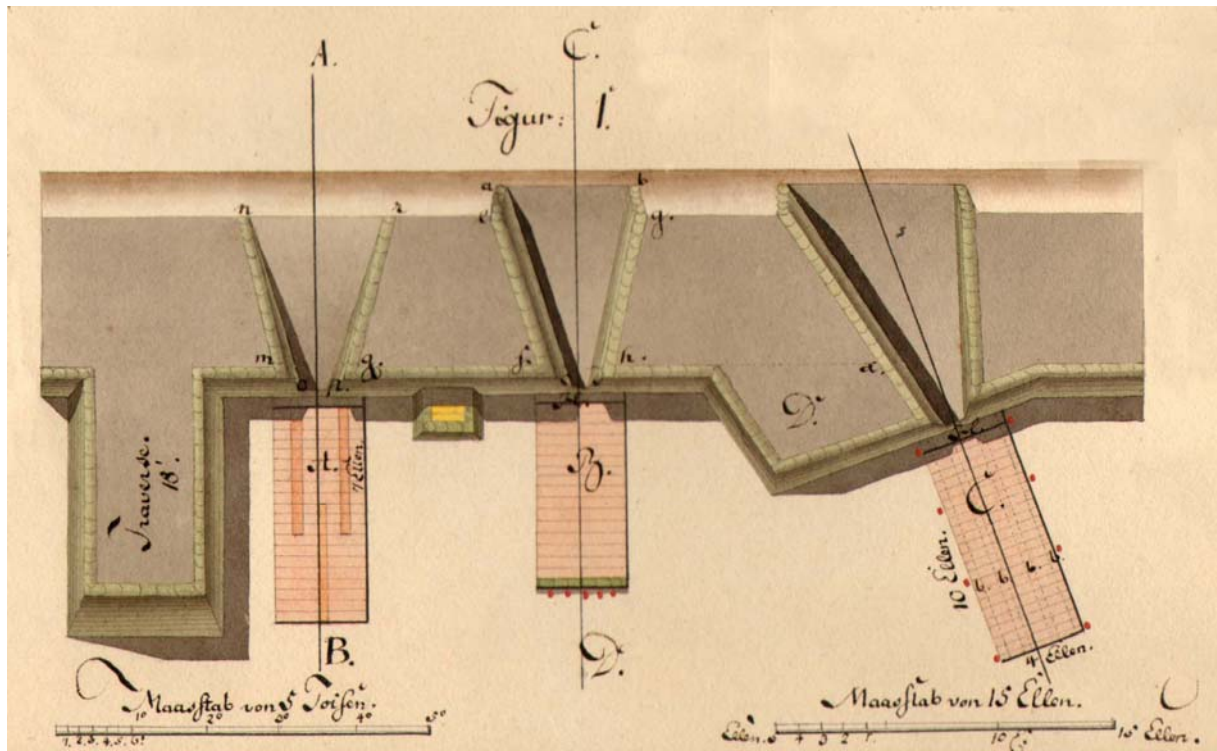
Aufsicht auf eine Horizontalbatterie mit Deckwall, Traverse, Ricochet-Bettung (A), Bettung für Horizontalfeuer (B) und schräg eingeschnittener Scharte (C). Wohl Prüfungsaufgabe von Heinrich-Wilhelm von Witzleben, Eleve an der adeligen Kadettenschule, Dresden 1823, nachmaligem Infanterieoffizier (Witzleben (c) Autor)
